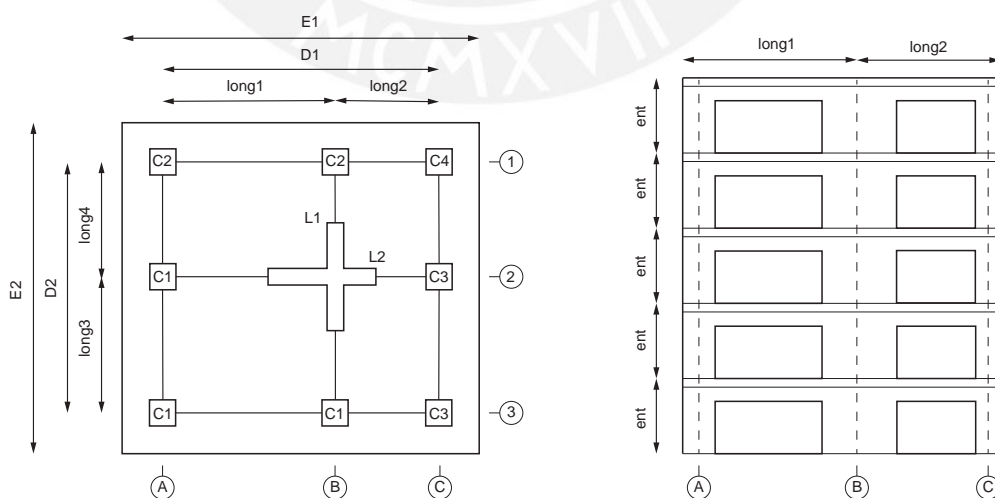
Planta estructural del análisis paramétrico realizado por Lopez y Fernandez-Davila (2018)
